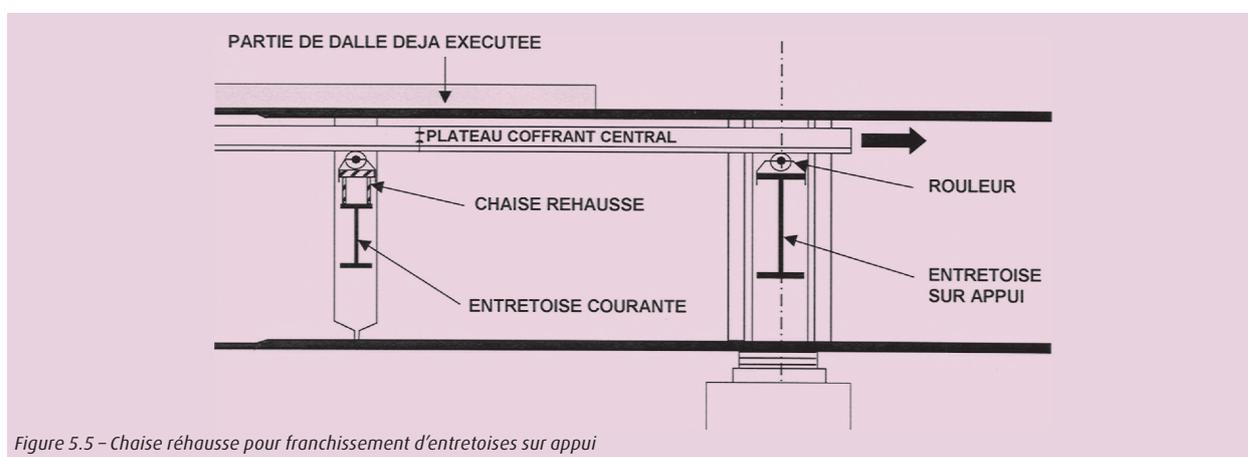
Chaise réhaussée pour franchissement d'entretoises sur appui
